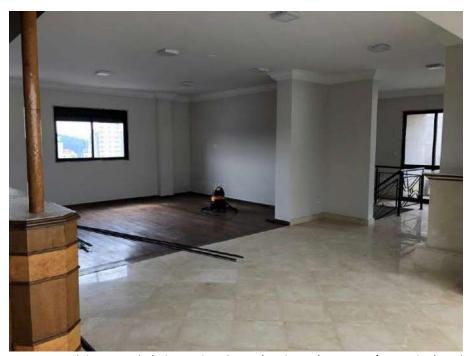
Vista parcial de outro ângulo da sala com área de lareira.
